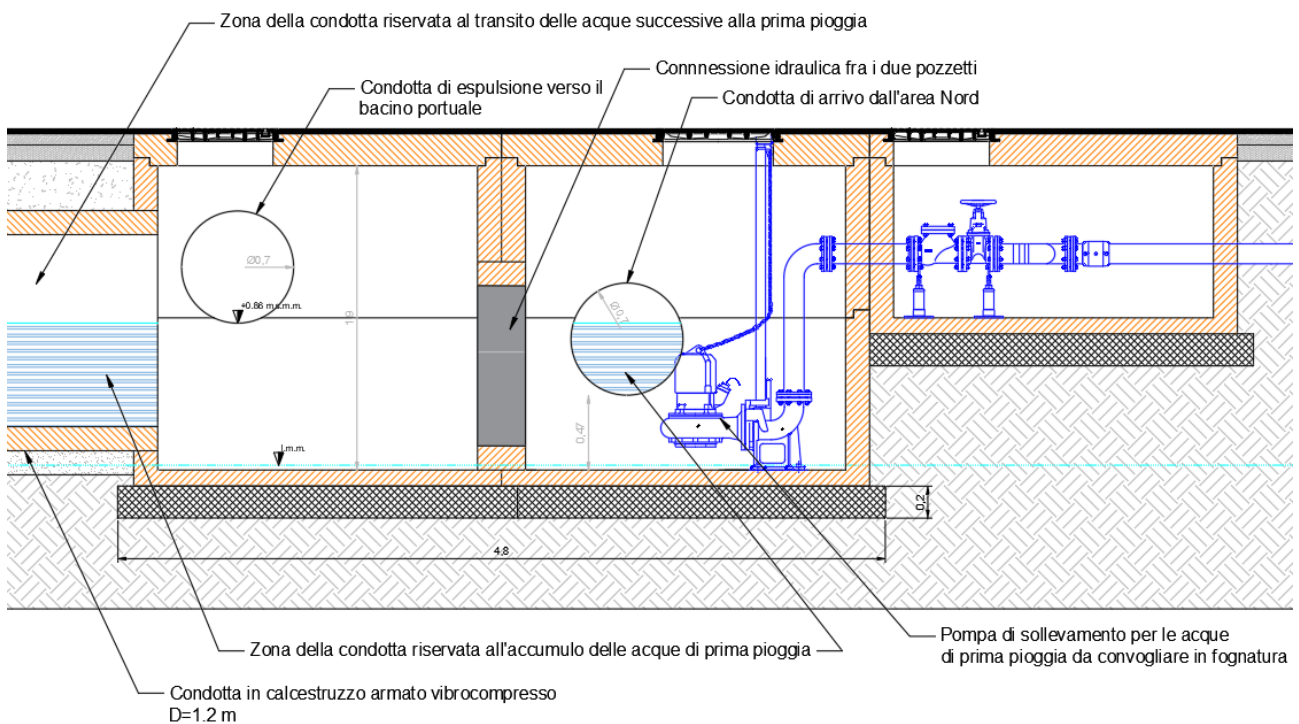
Sezione trasversale del pozzetto di smistamento.
